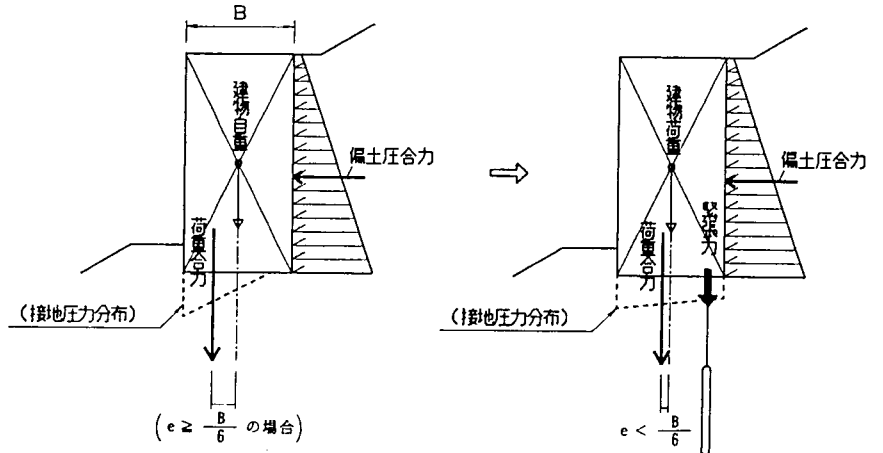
直接基礎の場合の転倒に対する抵抗
